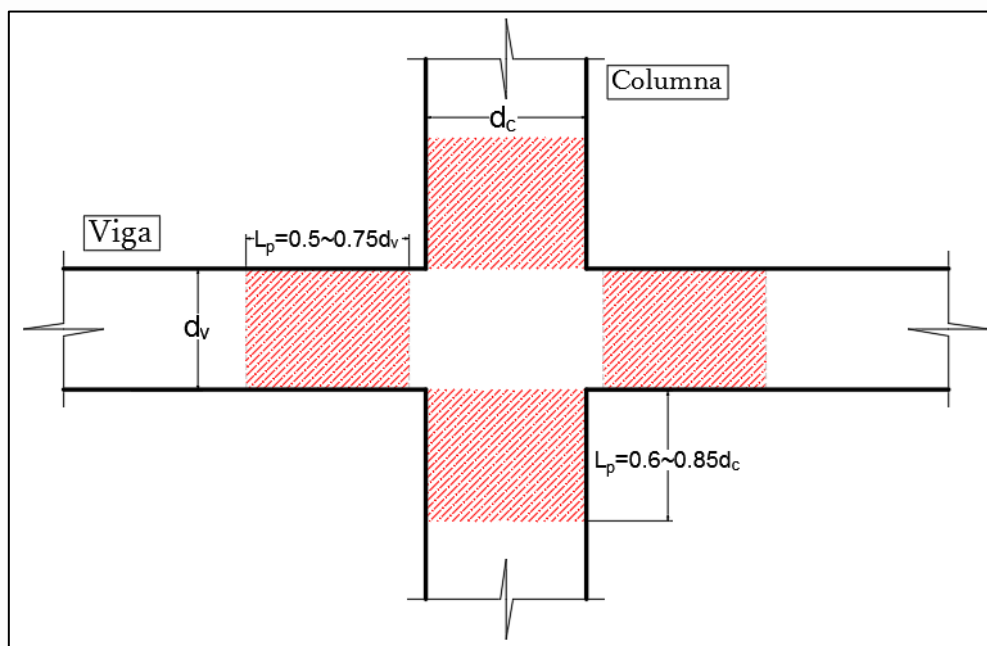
Longitud de rótulas plásticas en vigas y columnas según Asmat (2016)
